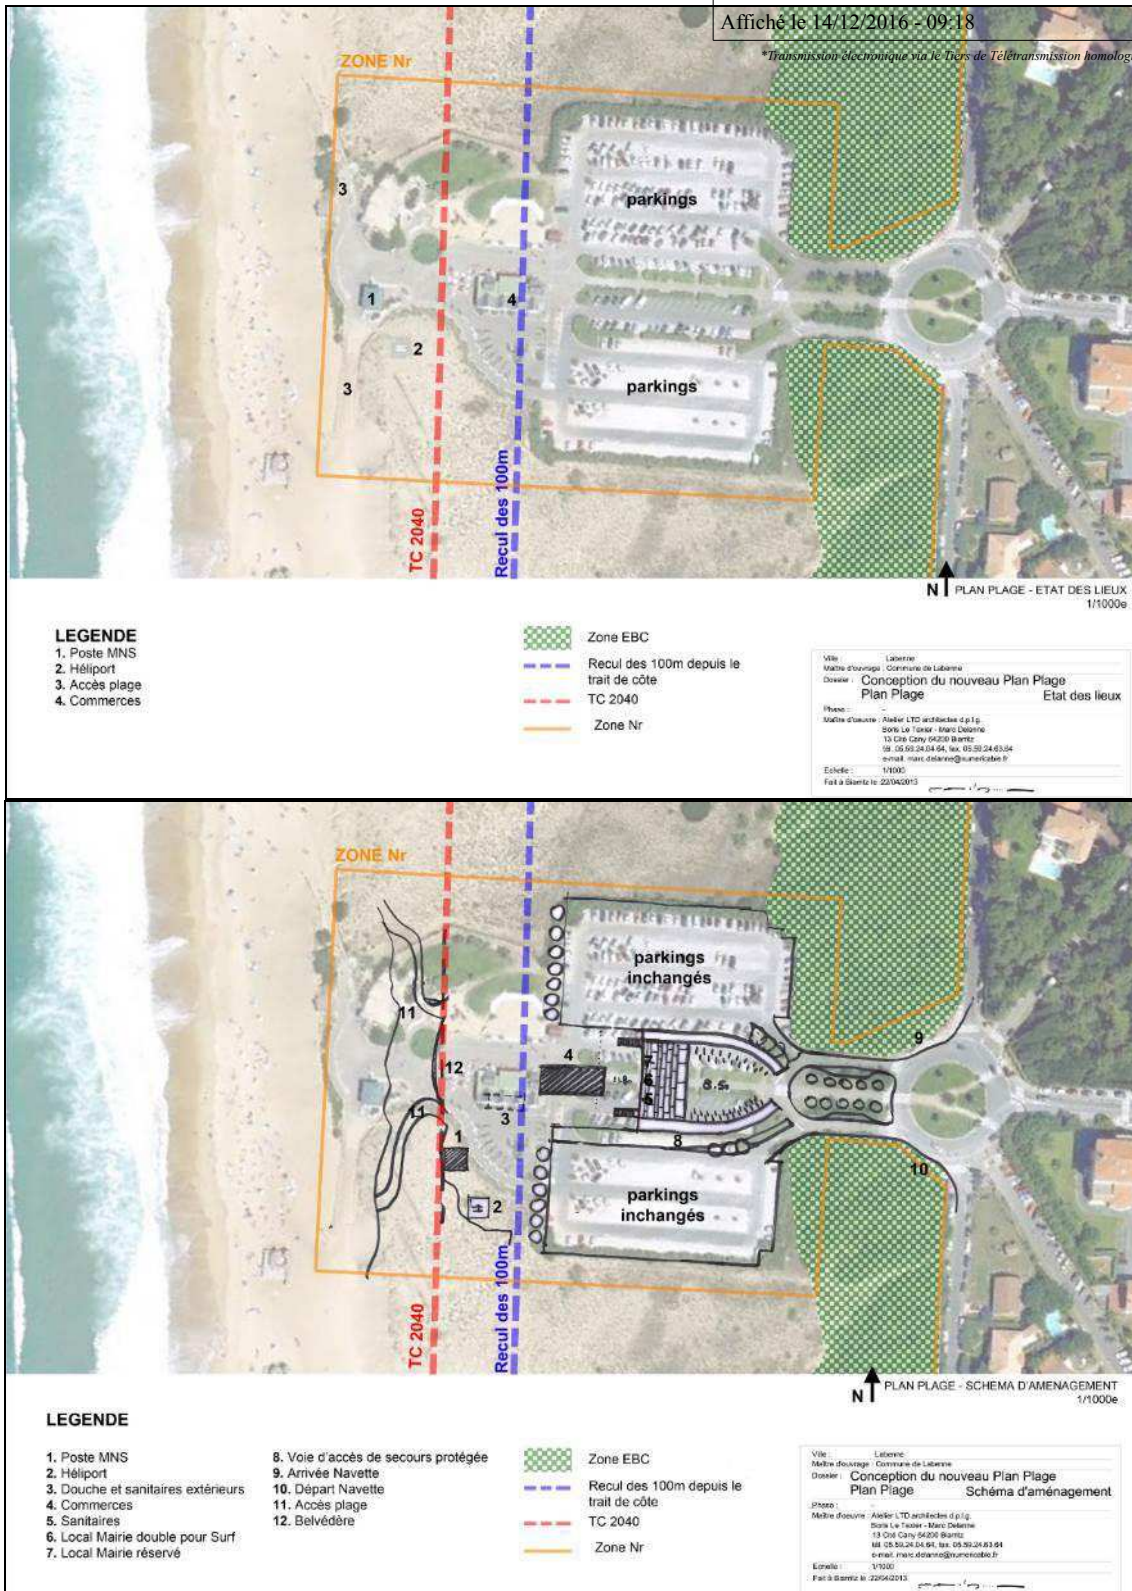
Etat des lieux et projet de schéma d'aménagement du Plan Plage de la commune de Labenne, avril 2013
